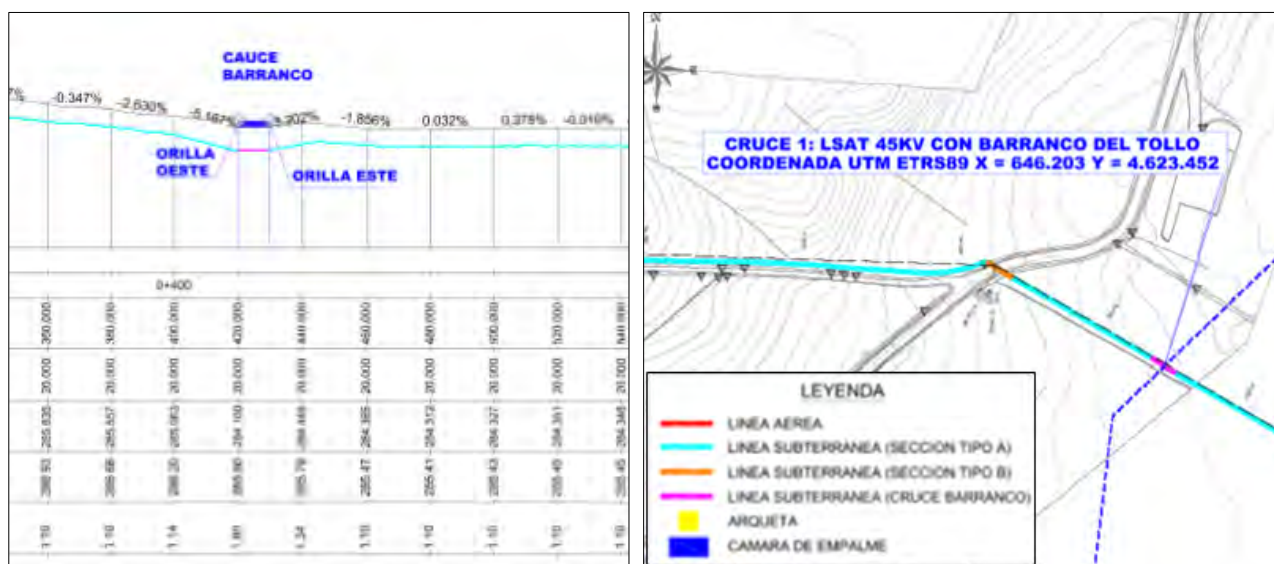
Ubicación del cruce de la LSAT en perfil longitudinal y plano de planta. La zona de vaguada asociada al cauce sería de aproximadamente 10 m.
